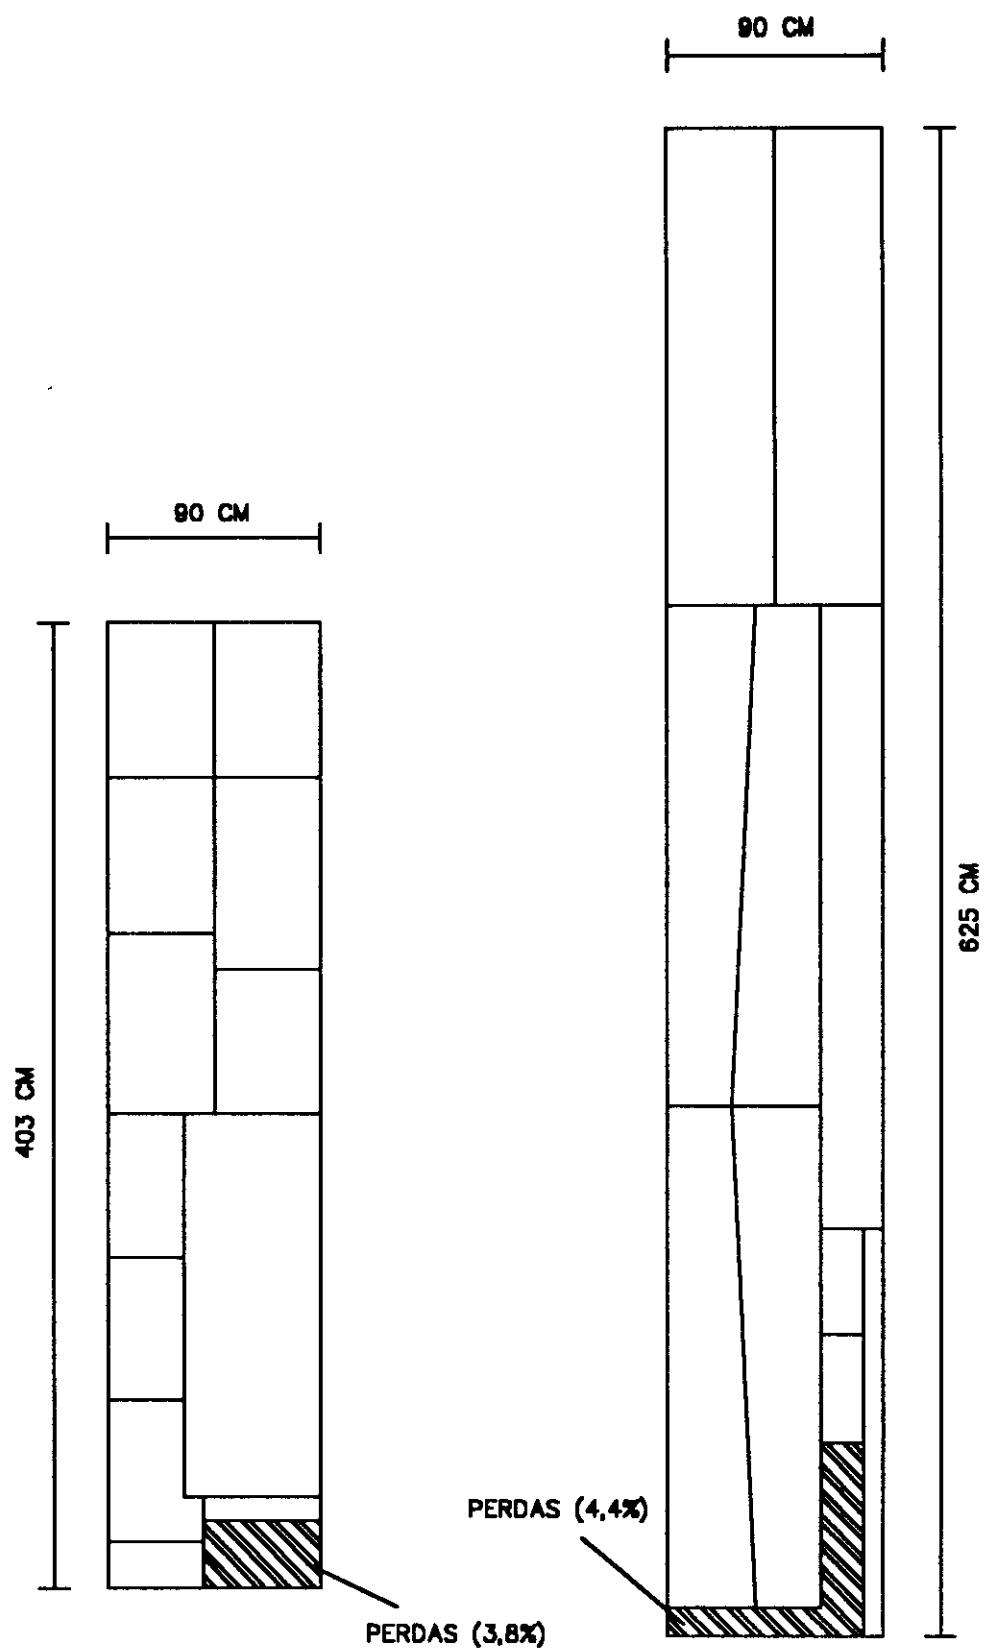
Esquema de um dos planos de corte utilizados no Cedec/Emurb.
